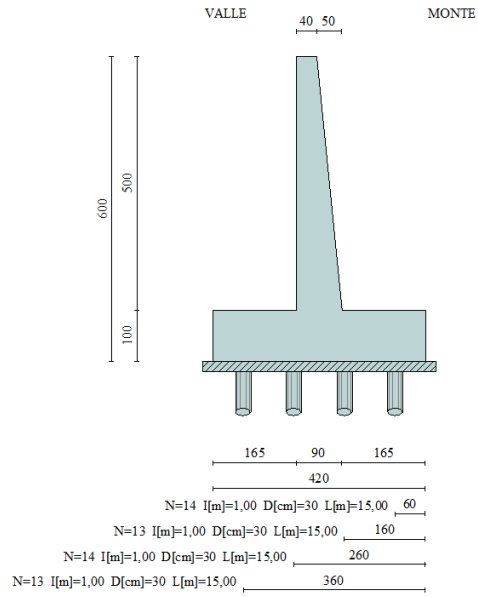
Muro Tipo C: geometria del muro di sostegno.
